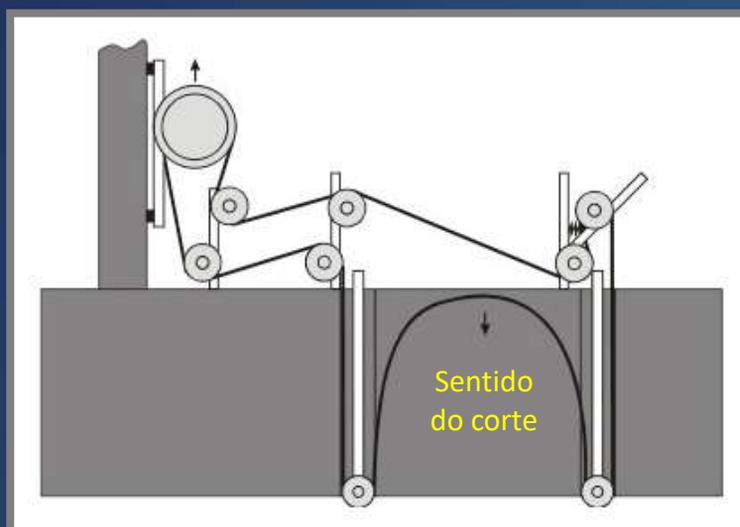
Corte com fio diamantado com polias submersas, corte invertido
